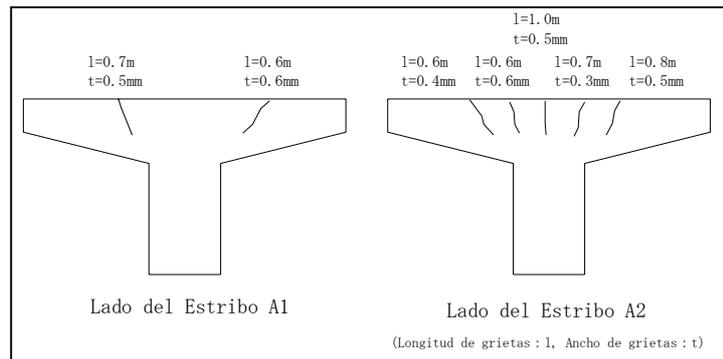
Estado de las Grietas en el Capitel de la Pilastra
